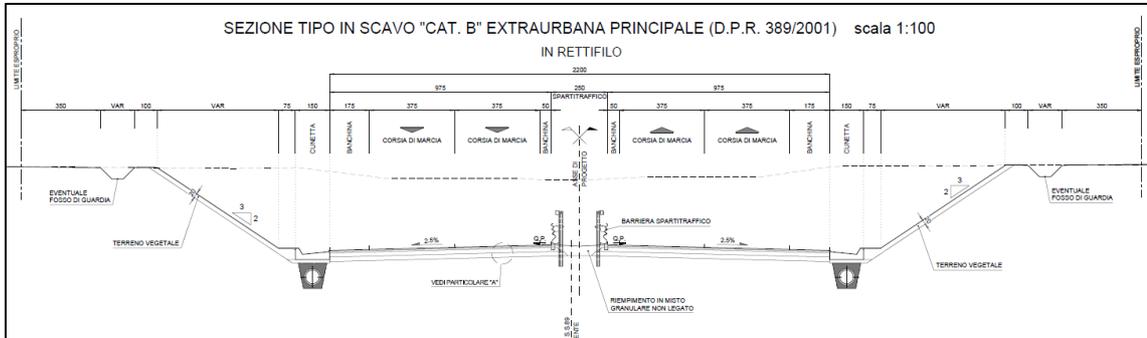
Sezione tipo asse principale, trincea, rettilifo. (stralcio elaborato T00PS00TRAST01A allegato al Progetto Definitivo)
